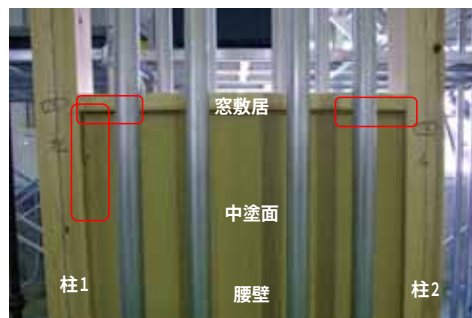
中塗側 1/75rad 窓敷居・柱周りのひび割れ
